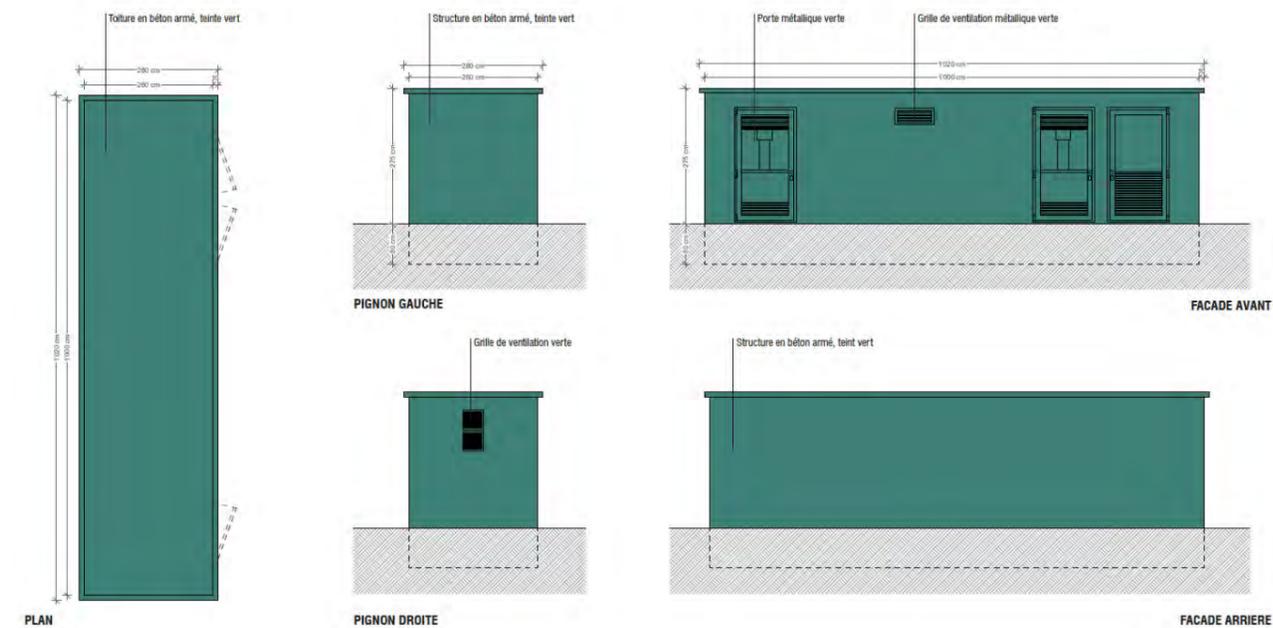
Plan de coupe et façades du poste de livraison HTA retenue
